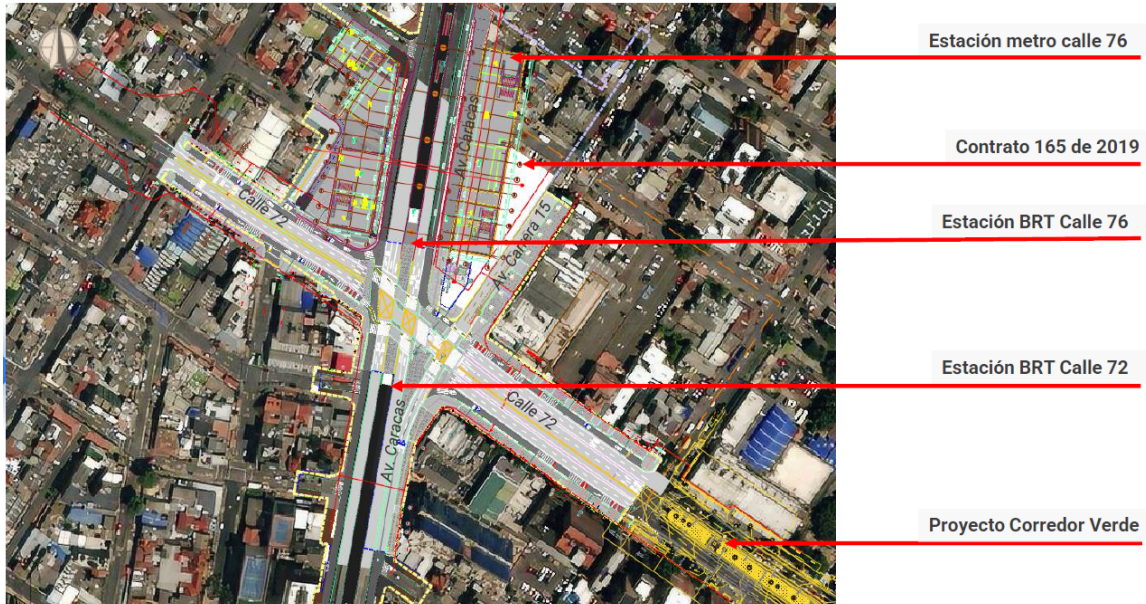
Localización del proyecto en construcción de la intersección de la Calle 72 y el Proyecto Corredor Verde
